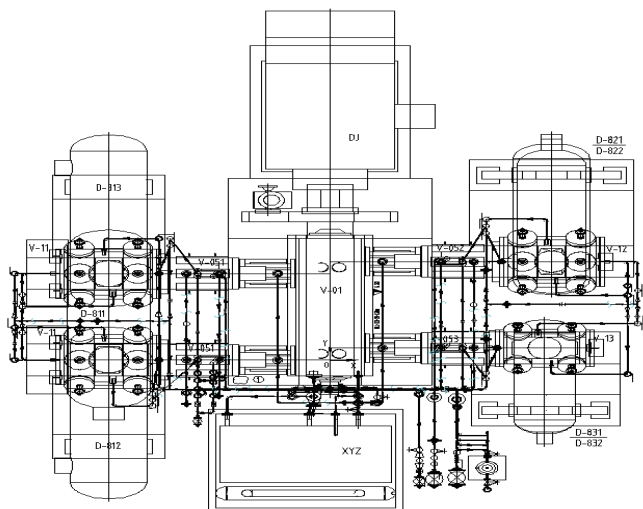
某甲醇制氢装置中解吸气压缩机辅助管线布置平面图
